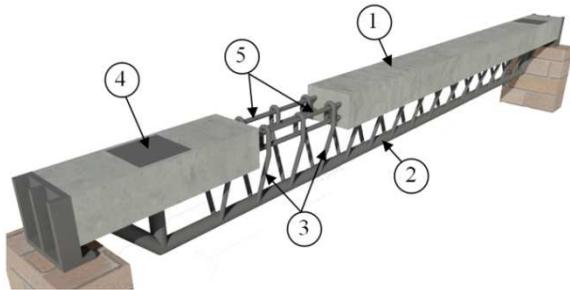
Загальний вигляд зразка серії Б-1, 1. залізобетонна лінійна складова; 2. дротяна арматура; 3,4. анкери; 5. арматурна сітка.
